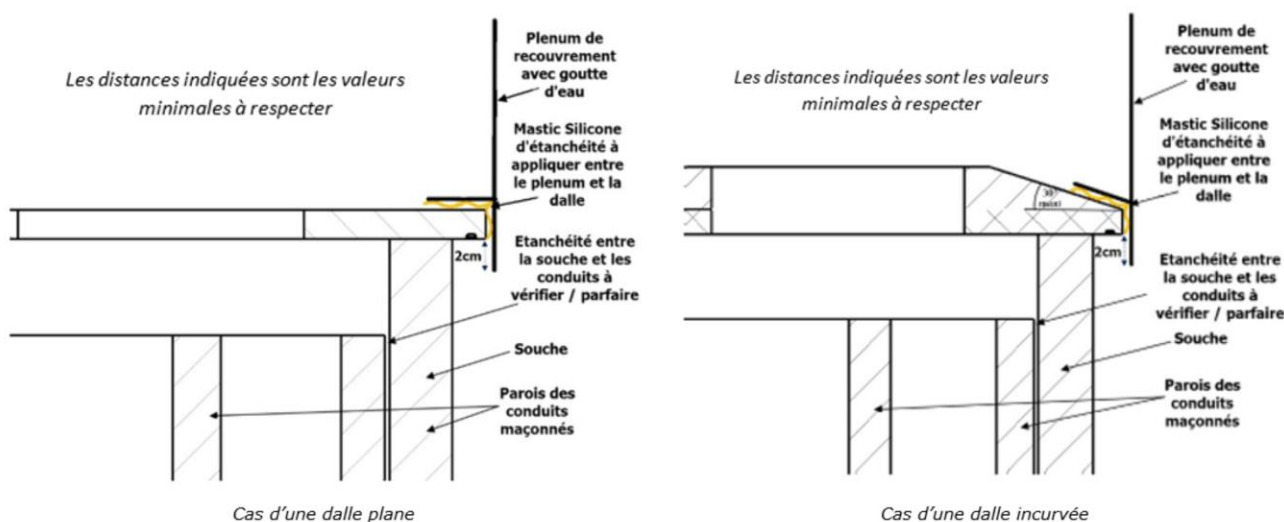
Coupes verticales d'un plénum de recouvrement avec goutte d'eau sur dalle conservée
